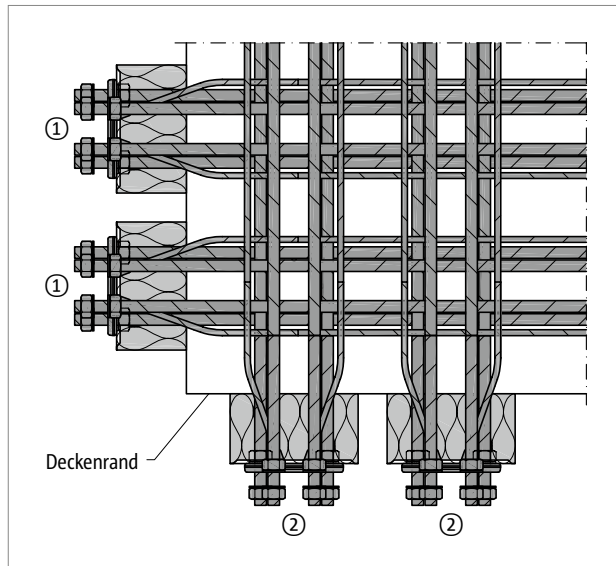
Schöck Isokorb® XT Typ SK: Außenecke
